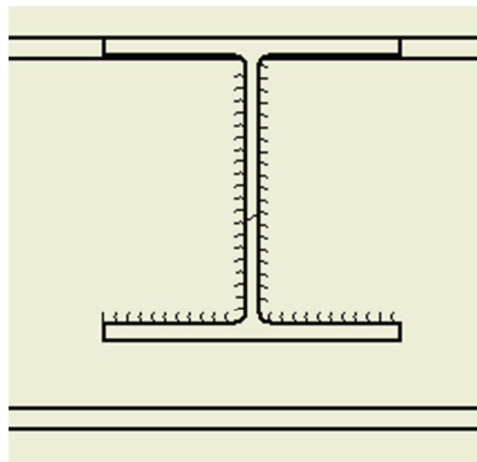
Soldadura Vigas principal-Viga secundaria
